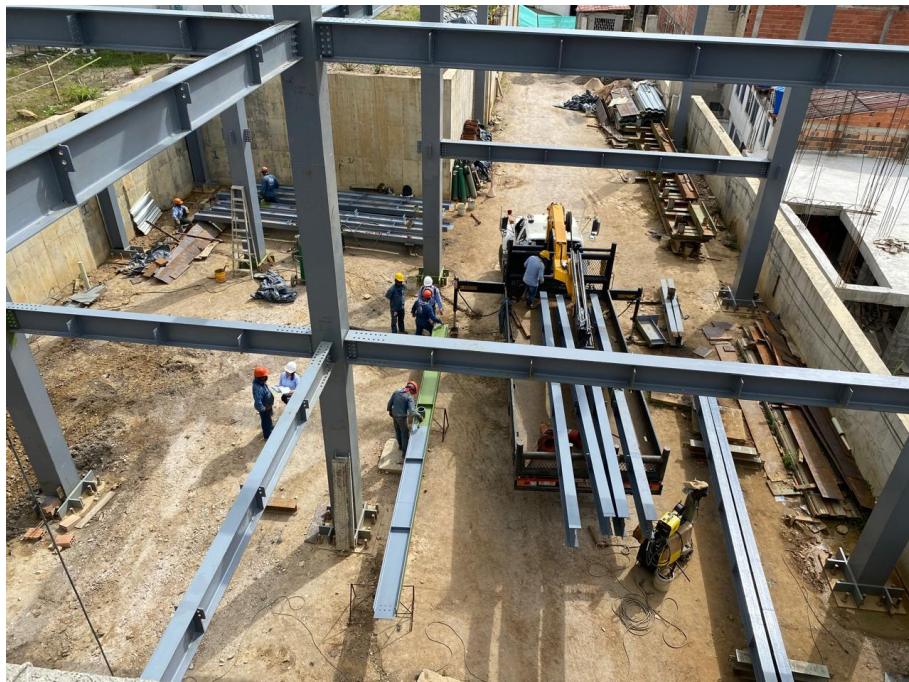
Posicionamiento de elementos estructurales metálicos con grúa
